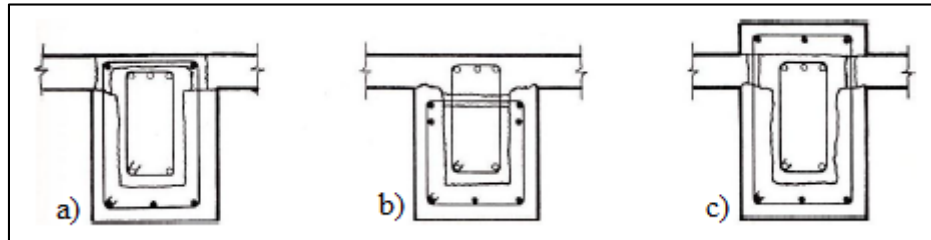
Encamisado por flexión y cortante de vigas con concreto reforzado.
